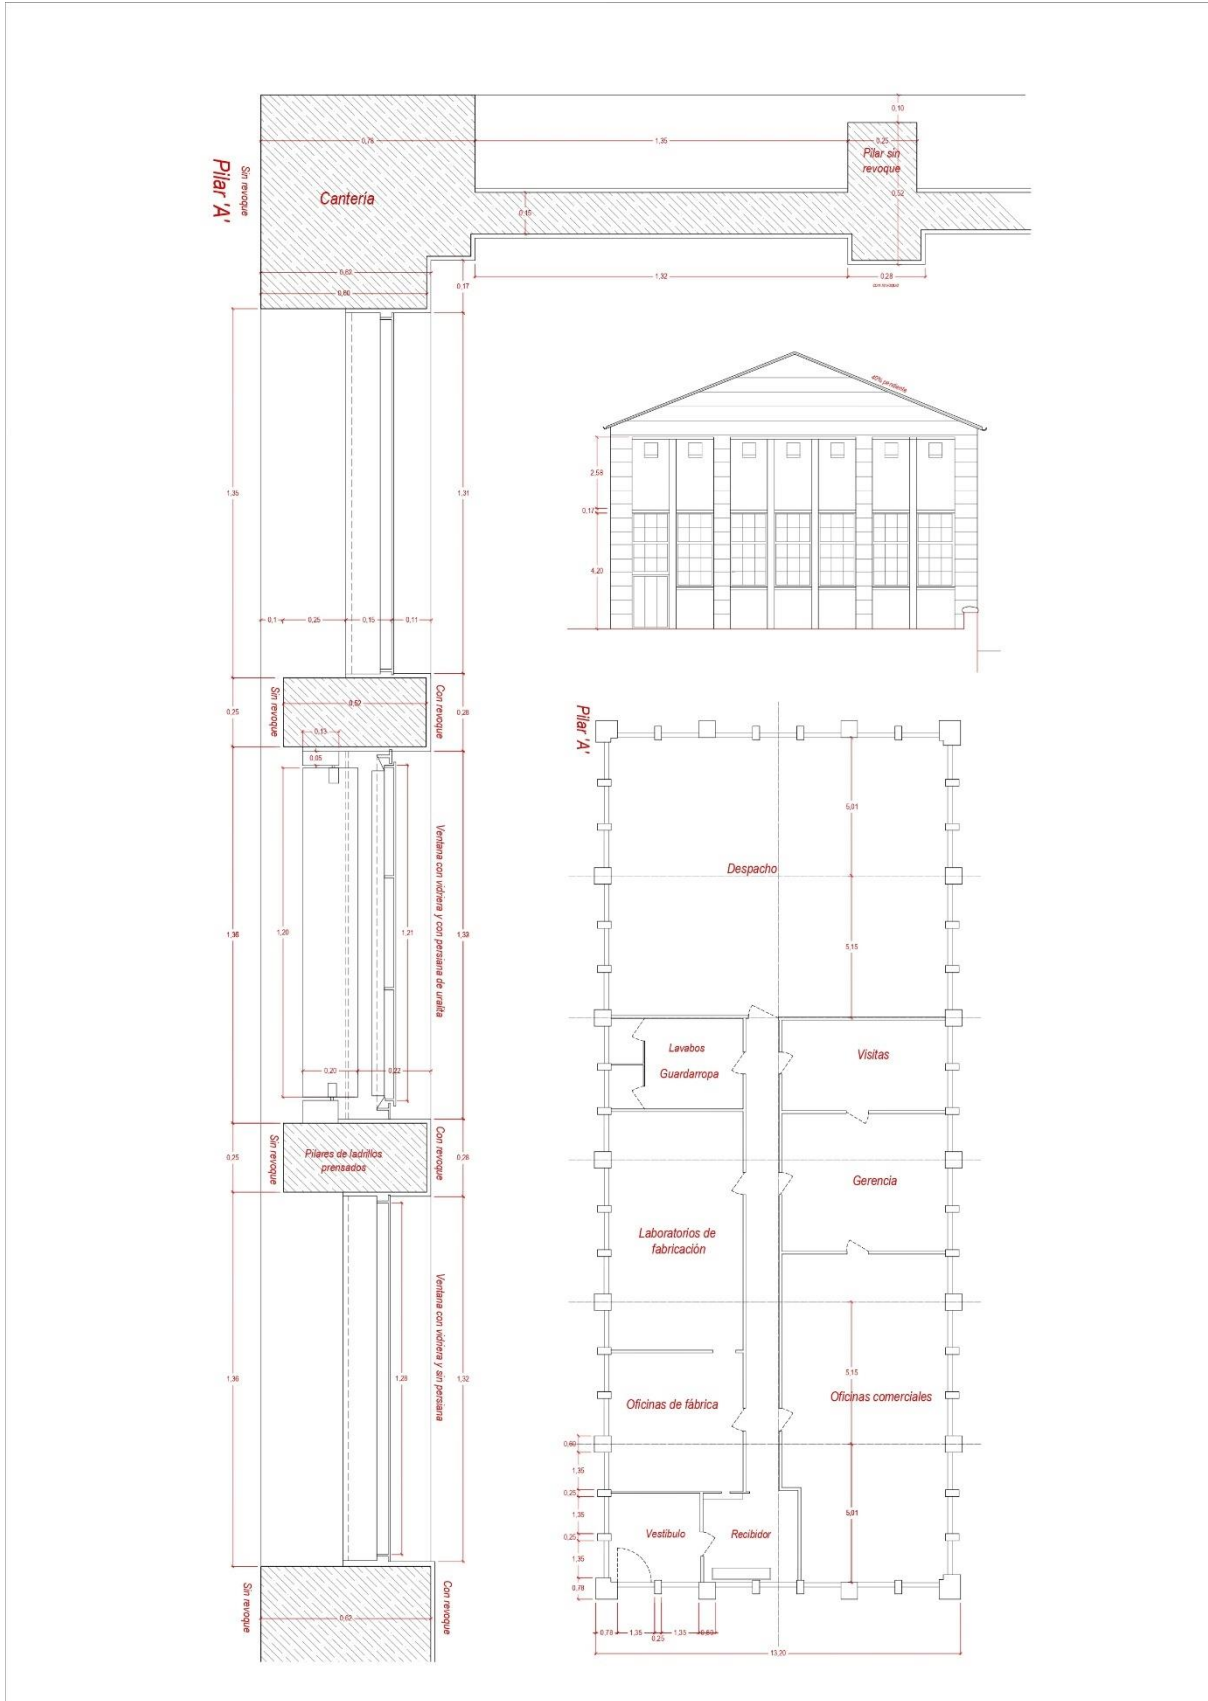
Despacho-Oficinas. Alzado (E 1:100) , planta baja (E 1:100) y su distribución y sección constructiva (E 1:10)
